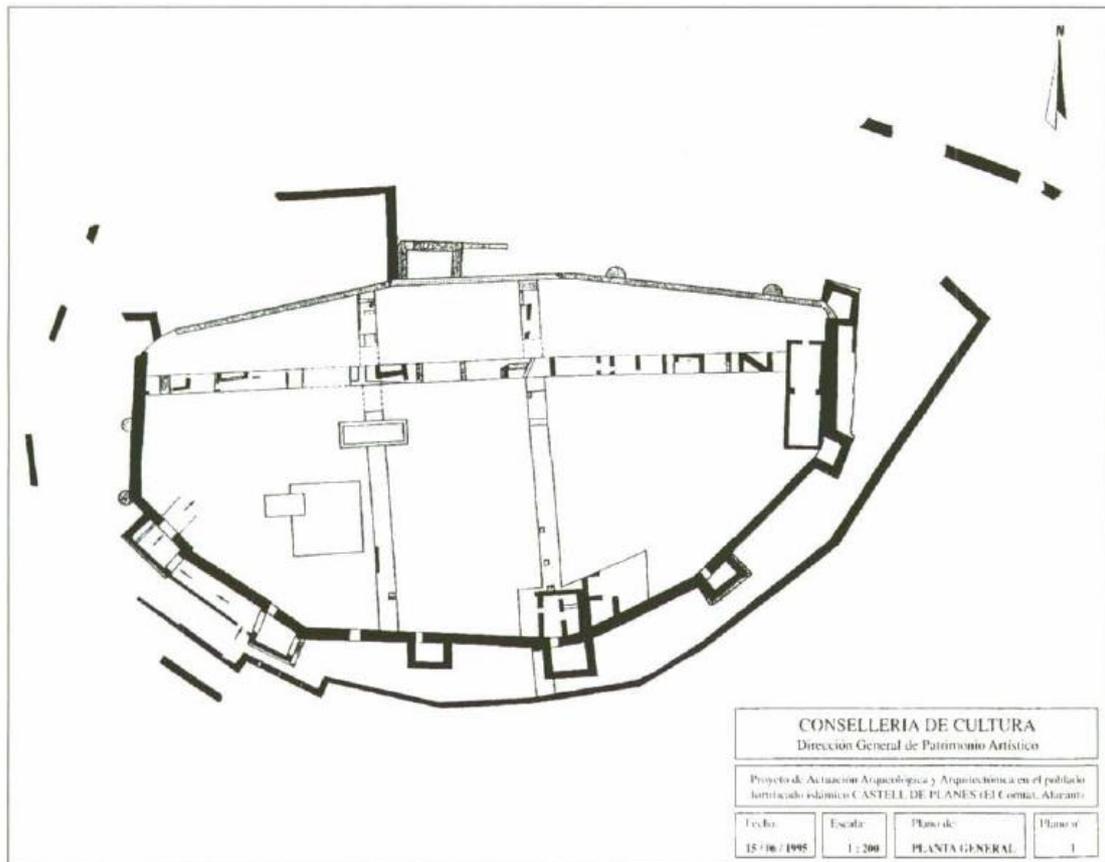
Planta del Castillo de Planes con las trazas de las estructuras exhumadas en la actuación arqueológica preliminar.
